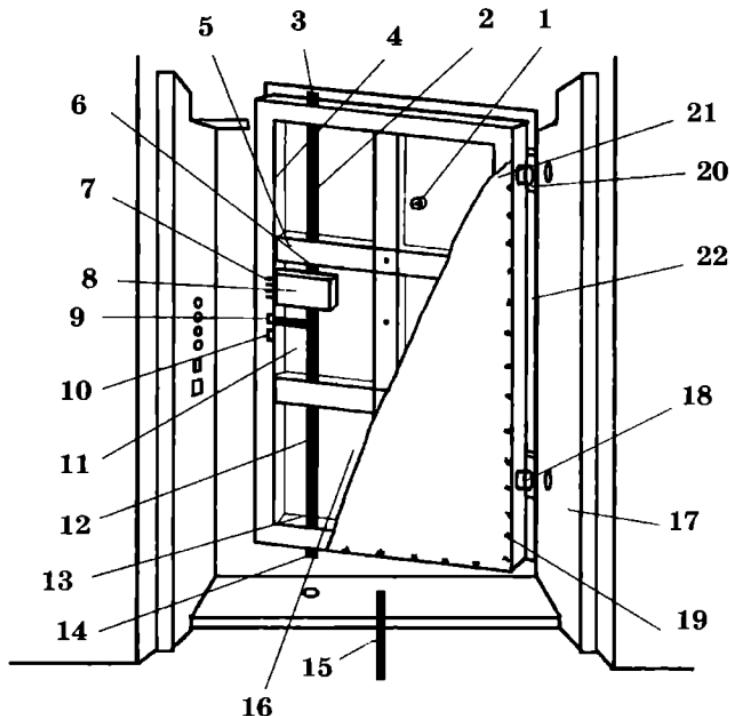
Конструкция защитной двери: 1 — глазок; 2 — верхний ригель основного замка; 3 — верхний запирающий штырь; 4 — каркас створки; 5 — люк для ремонта; 6 — крепление вертикальной тяги; 7 — ригели; 8 — сувальдный замок; 9 — защелка; 10 — ригель; 11 — вспомогательный замок; 12 — нижняя тяга замка; 13 — направляющая вертикальной тяги; 14 — нижний запирающий штырь; 15 — монтажный анкер; 16 — тепло- и звукоизолятор; 17 — коробка; 18 — противосъемный штырь; 19 — крепеж отделки; 20 — несущий петлевой уголок; 21 — задний стальной лист; 22 — передний стальной лист
